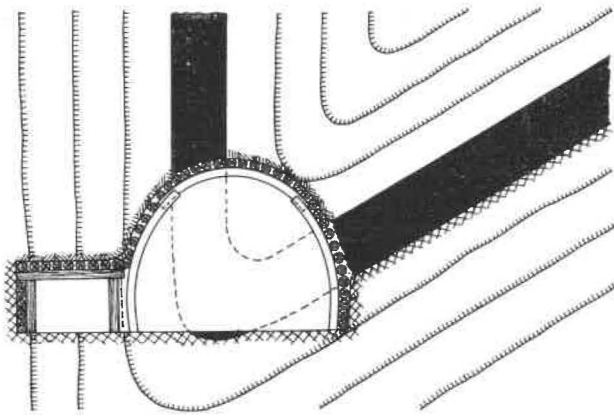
Voie de base en crochon de pied : soutènement provisoire en cadres Toussaint-Heintzmann.
